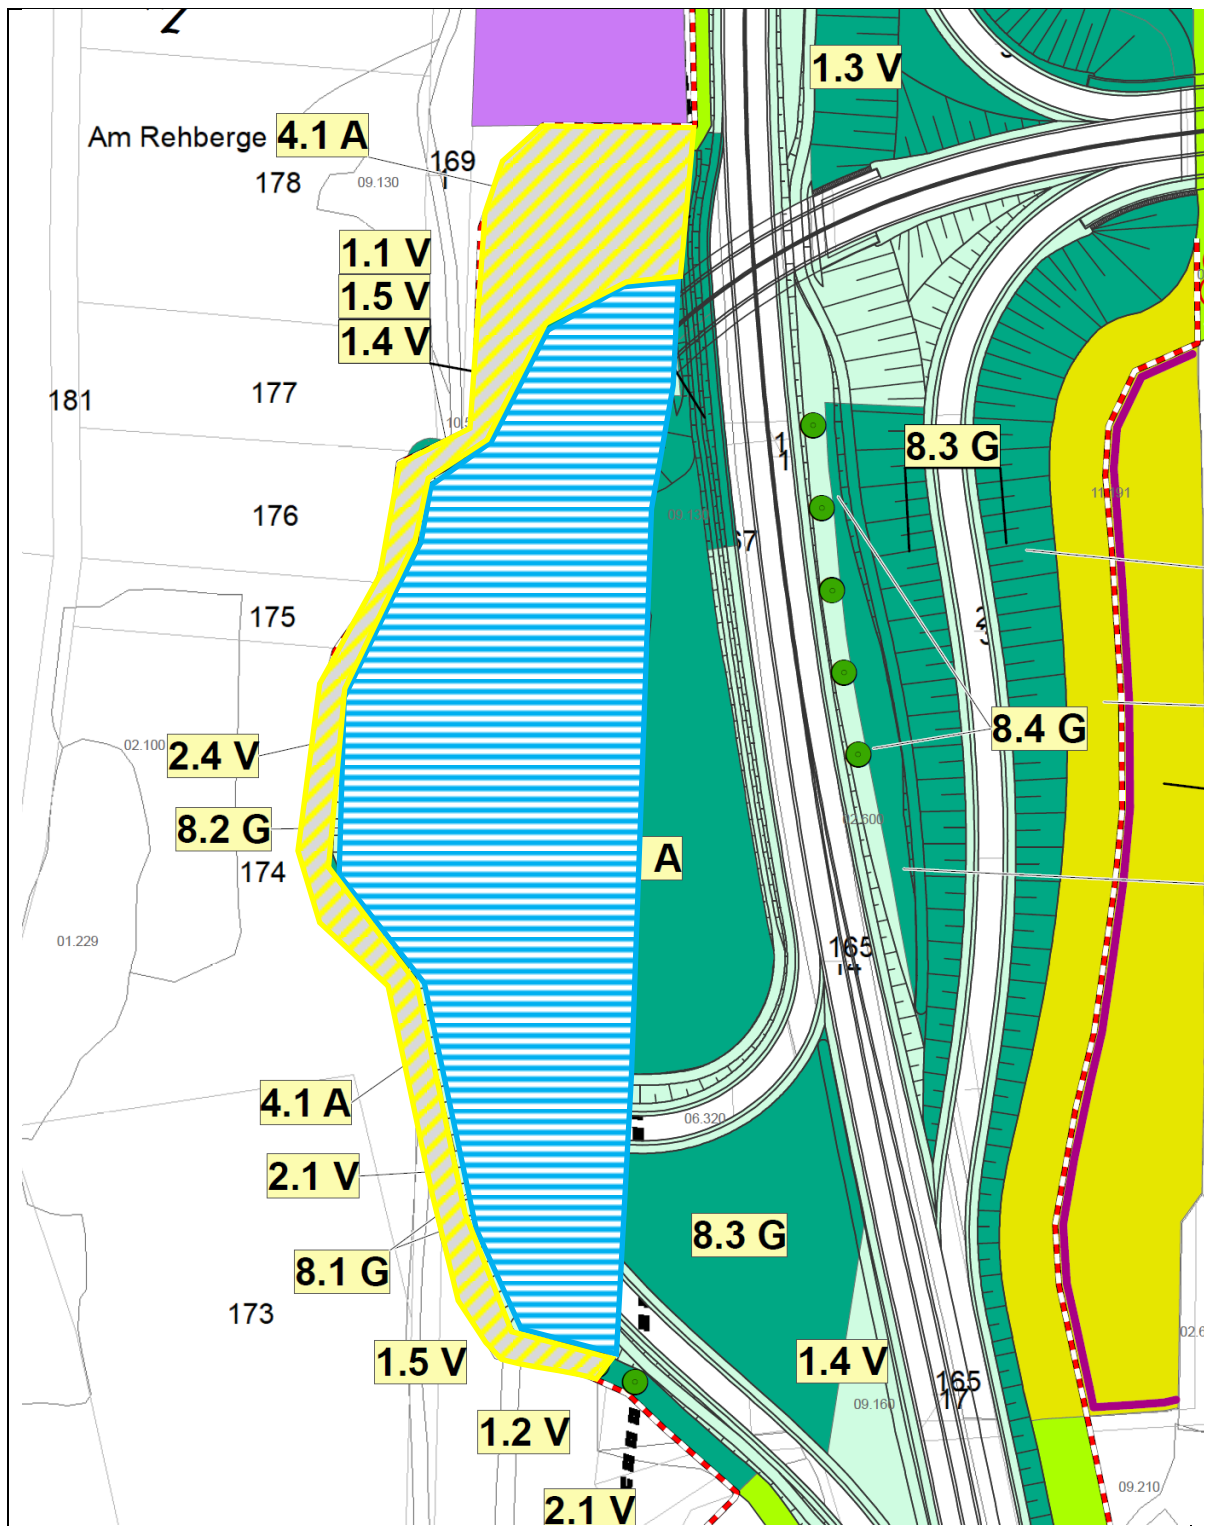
Ausschnitt aus dem Maßnahmenplan mit Waldverlustflächen (hellblau schraffiert = dauerhaft, gelb schraffiert = temporär)
